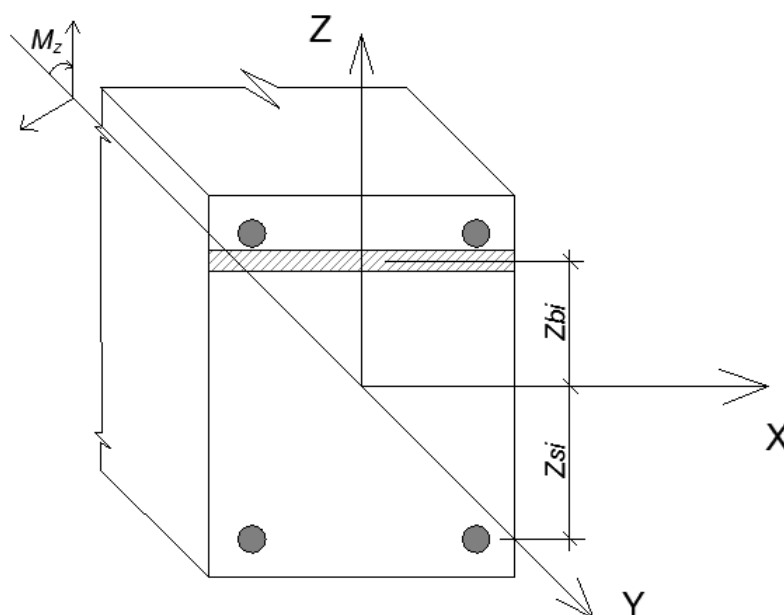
Расчетное сечение прямоугольного железобетонного элемента при действии изгибающего момента
